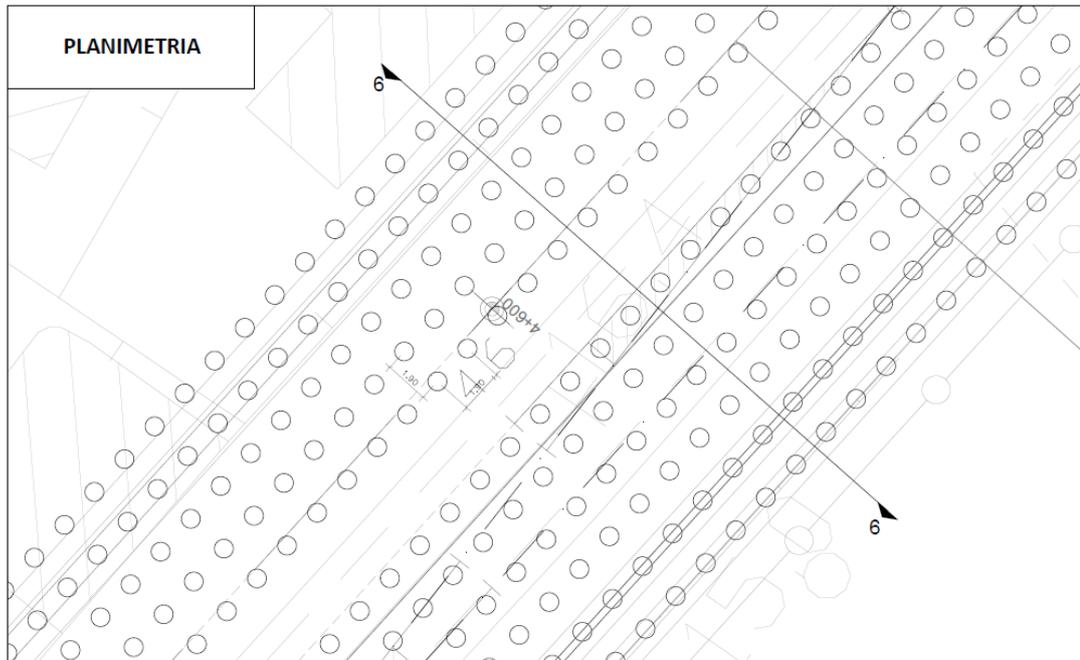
Sezione rappresentativa tratta 4+500 - 4+800 - planimetria
